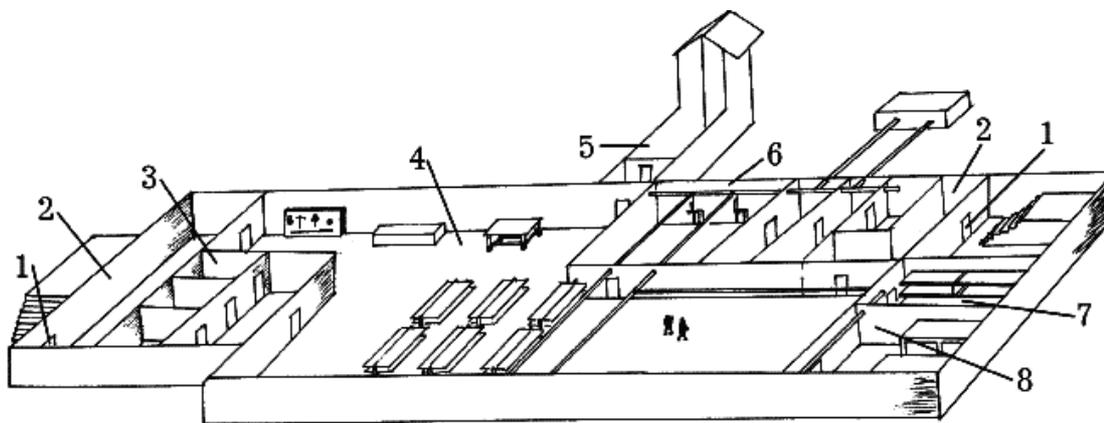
Планировка убежища: 1 – защитно-герметические двери, 2 – шлюзовые камеры, 3 – санитарно-бытовые отсеки, 4 – основное помещение для размещения людей, 5 – галерея и оголовок аварийного выхода, 6 – фильтровентиляционный отсек, 7 – медицинская комната, 8 – кладовая для продуктов
